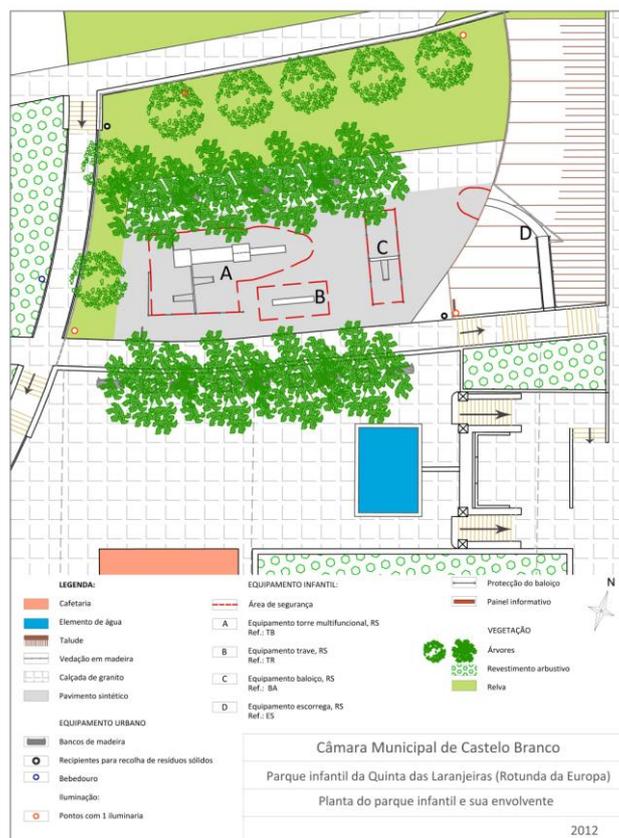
Planta do parque infantil da Quinta das Laranjeiras (Rotunda da Europa). (Planta elaborada pela autora)
